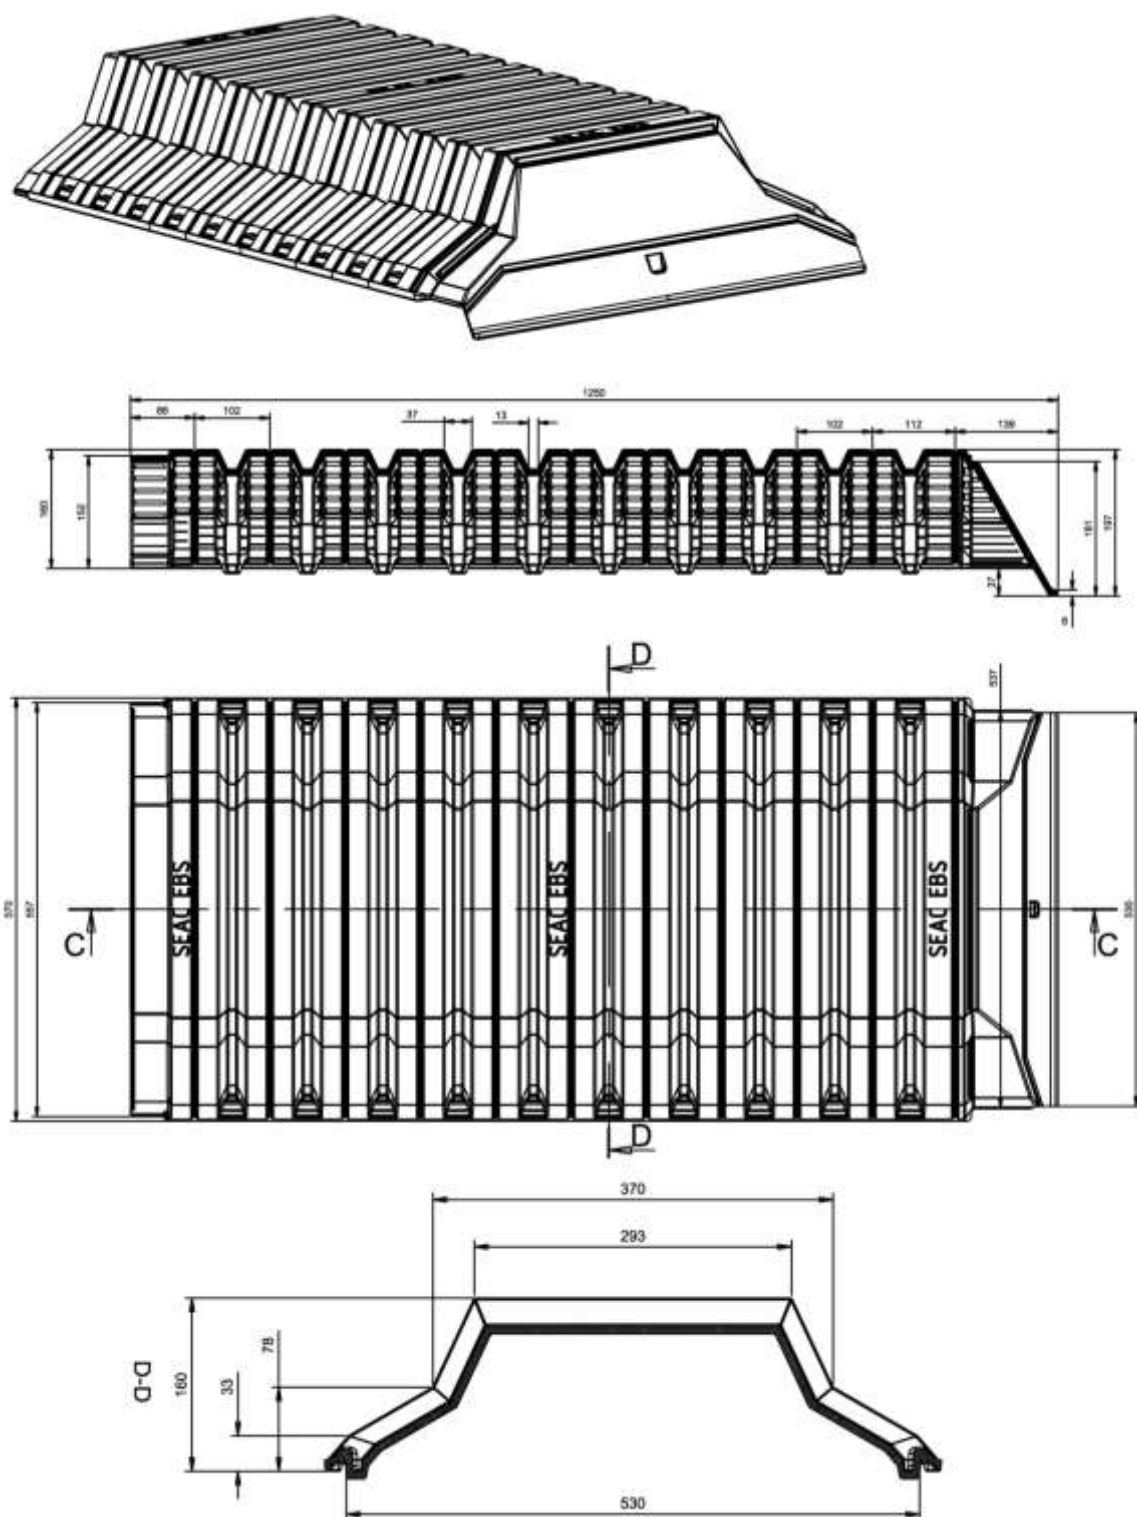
Définition entrevous EBS de 20 - Hauteur coffrante de 19,5 cm vues globale, longitudinale, de dessus et section transversale
